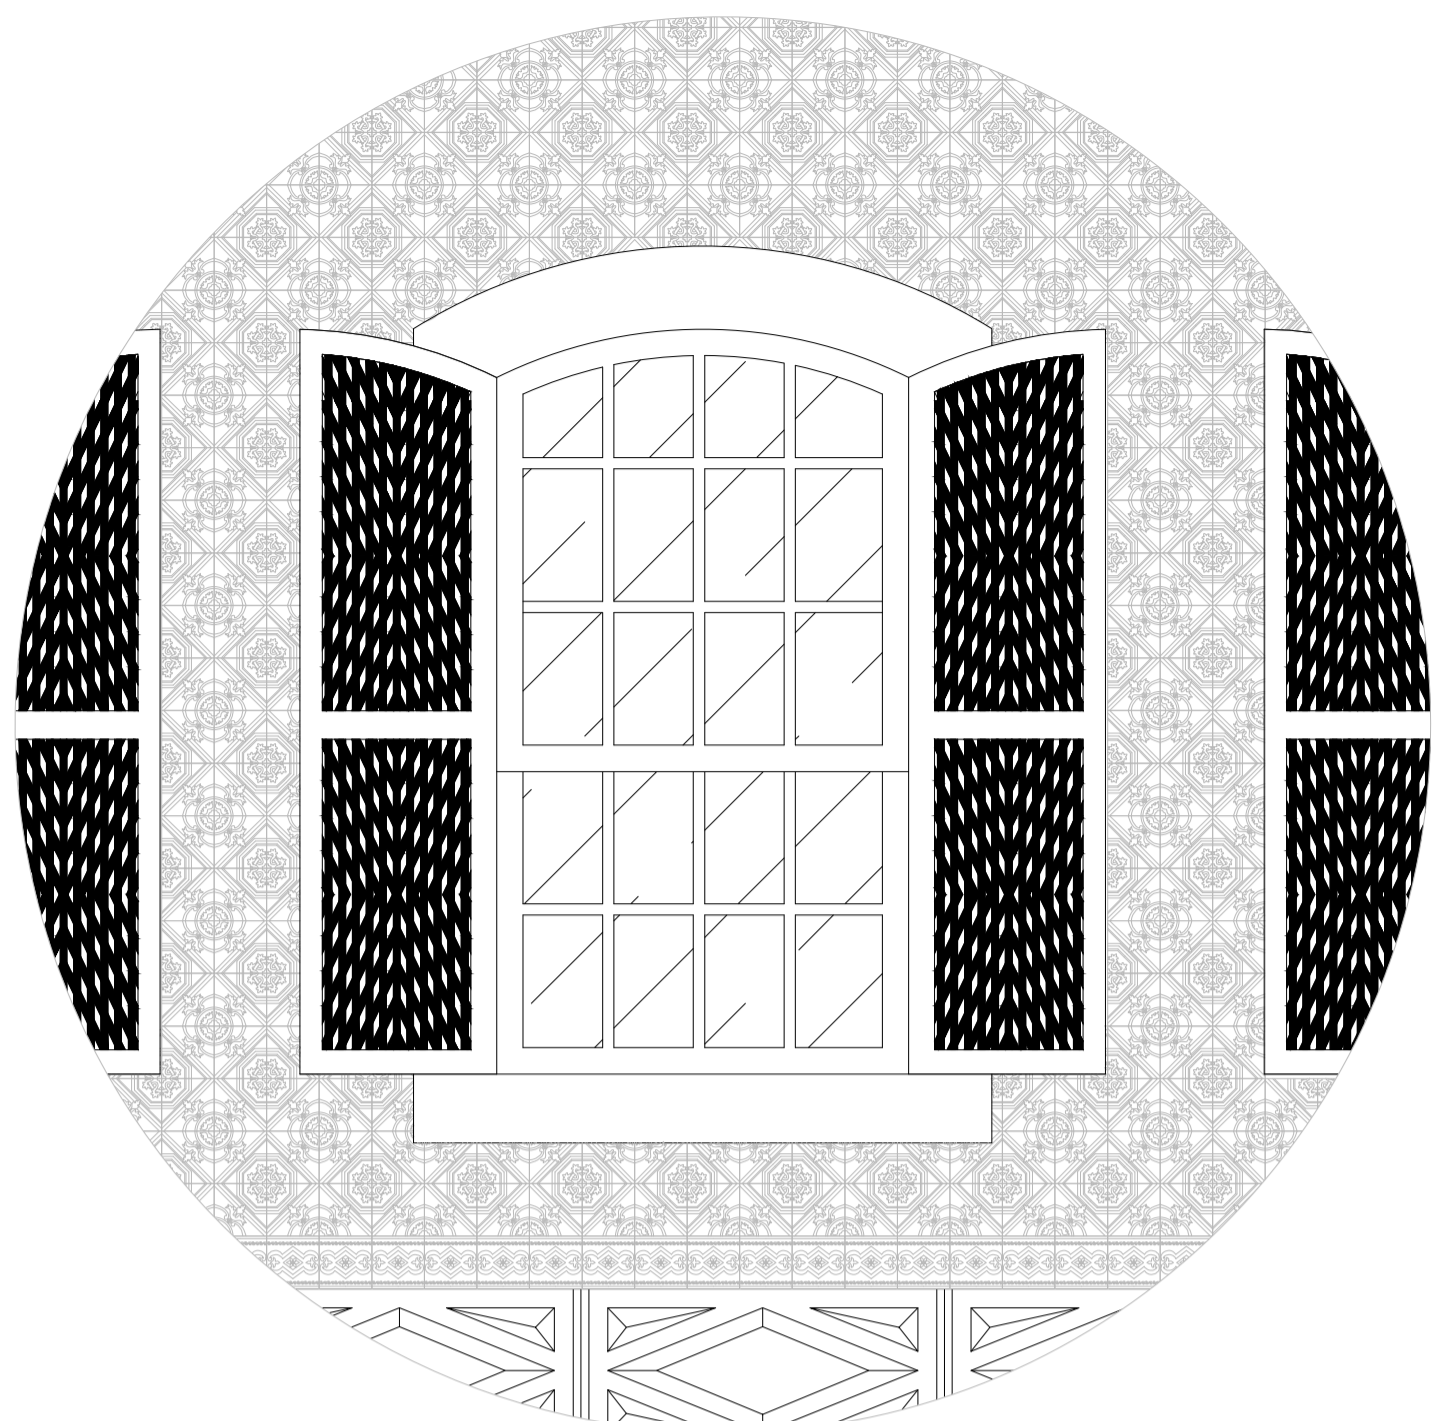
Azulejo francês com configuração semelhante ao azulejo de tipologia 3. Utilizado para revestimento de fachada em Pernambuco, Brasil.
